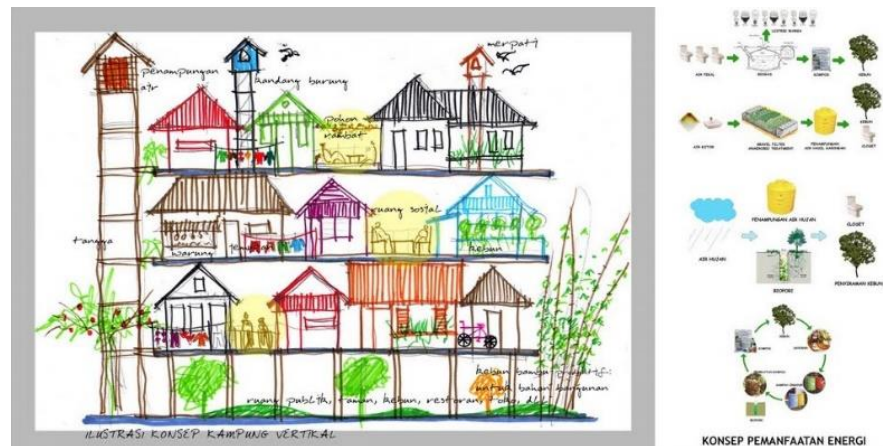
Fasilitas Publik Kampung Vertikal
